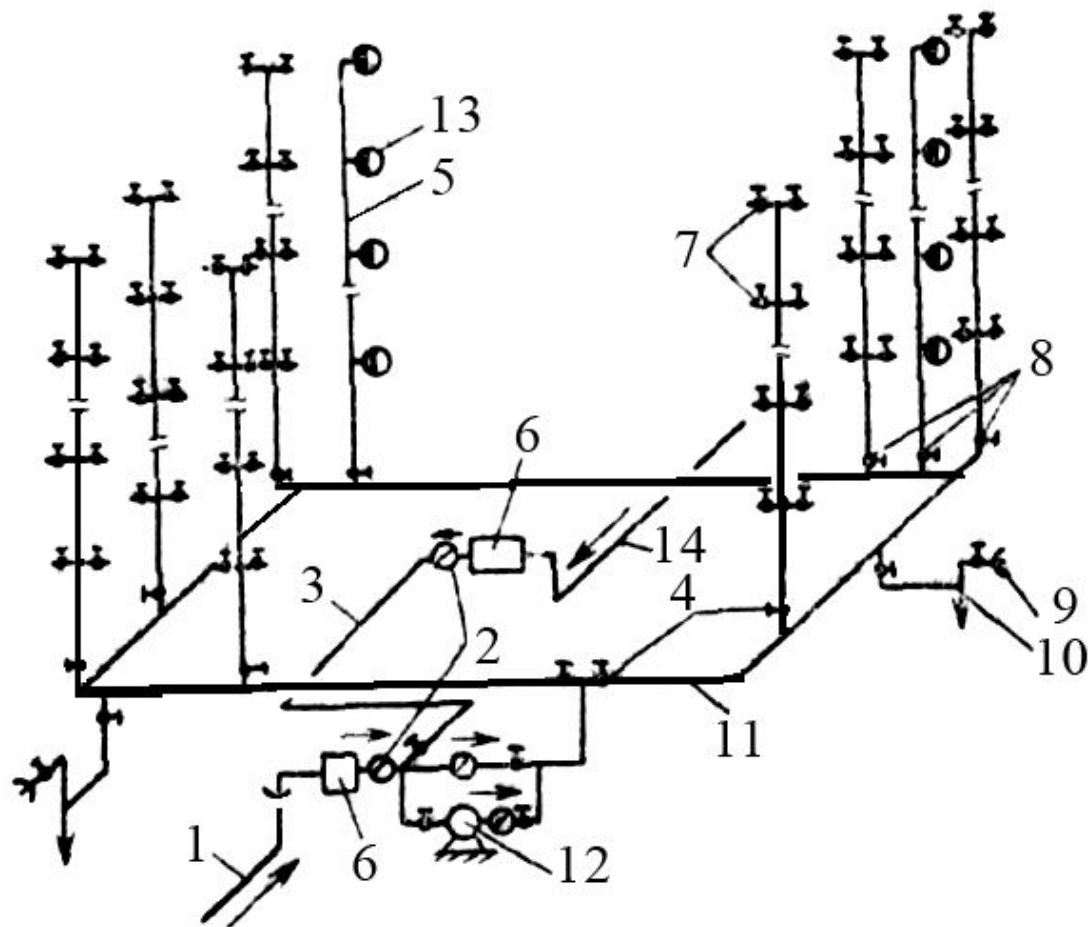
Система водоснабжения здания с повысительной насосной установкой: 1 – ввод № 1; 2 – обратный клапан; 3 – перемычка; 4 – запорная арматура; 5 – пожарный стояк; 6 – водомерный узел; 7 – вентиль на поэтажной разводке; 8 – монтажные запорные вентили; 9 – поливочный кран; 10 – спуск (пробка); 11 – кольцевая магистраль; 12 – насосная установка; 13 – пожарные краны; 14
